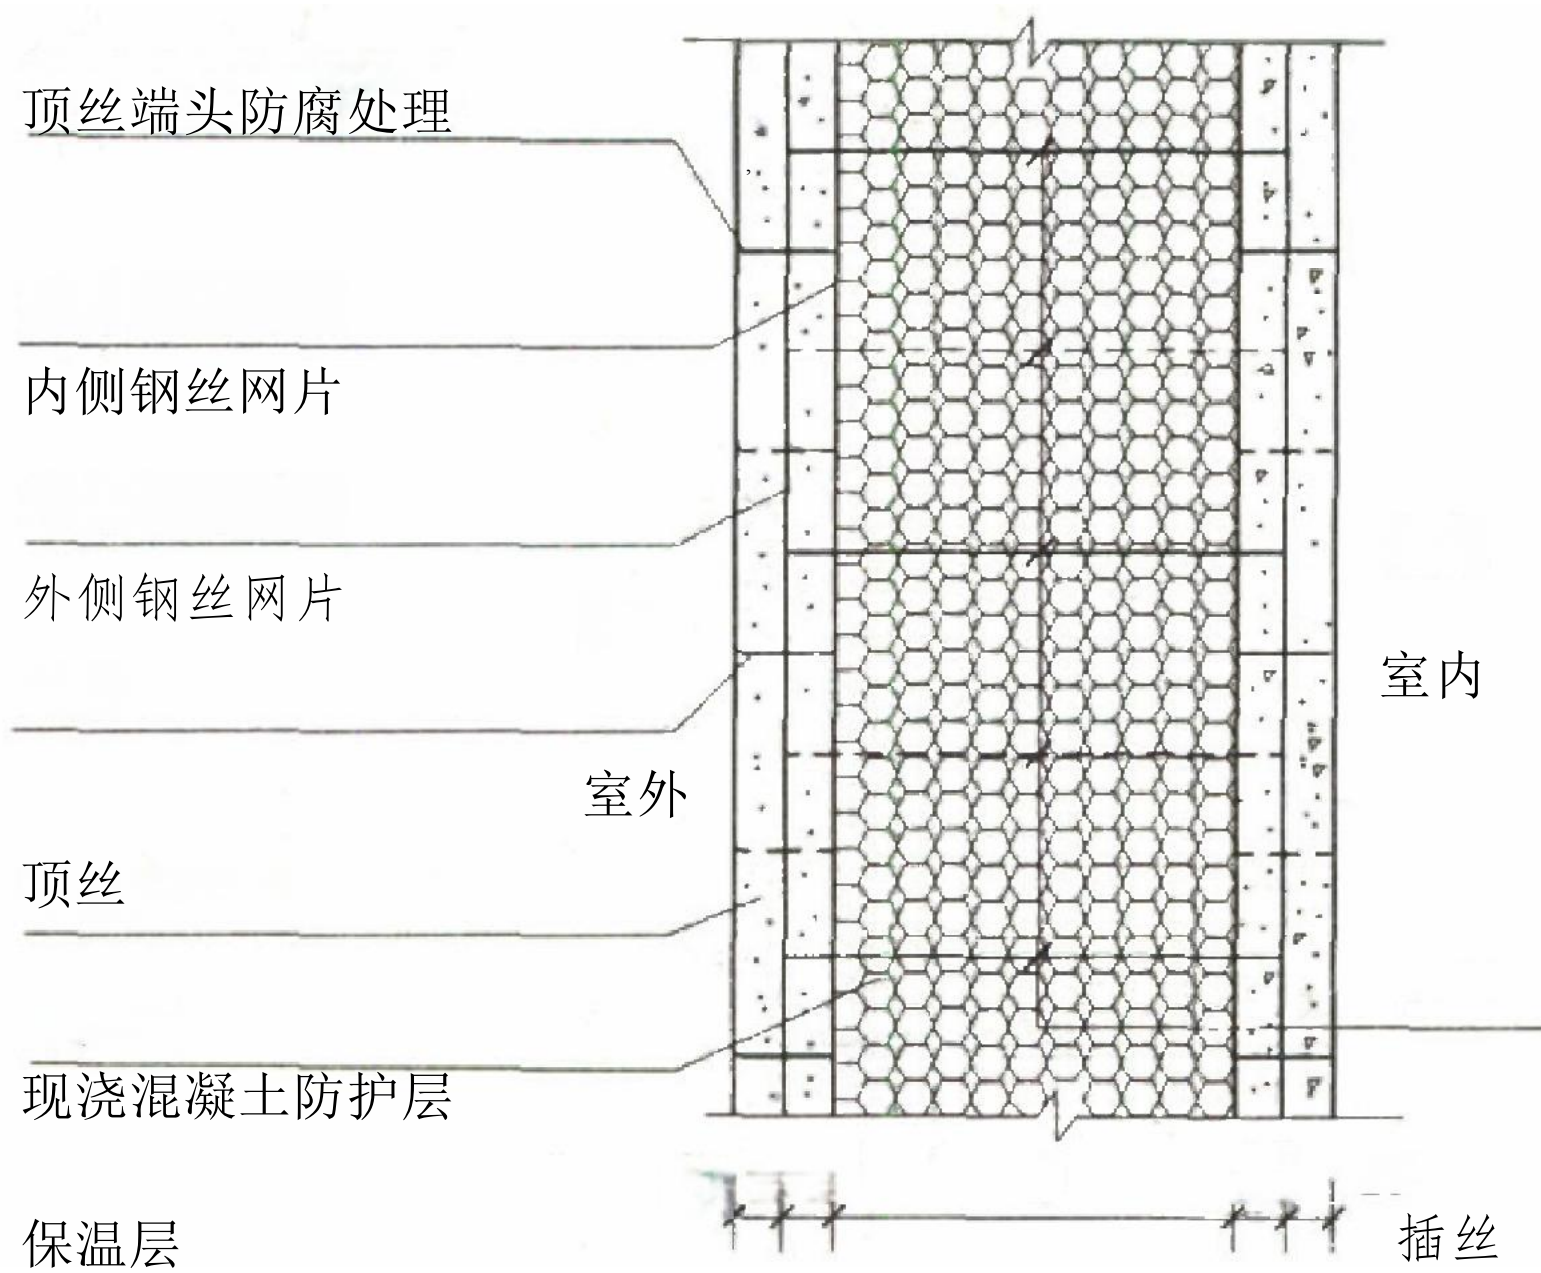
现浇混凝土内置保温填充墙构造示意图 (单位: mm)
